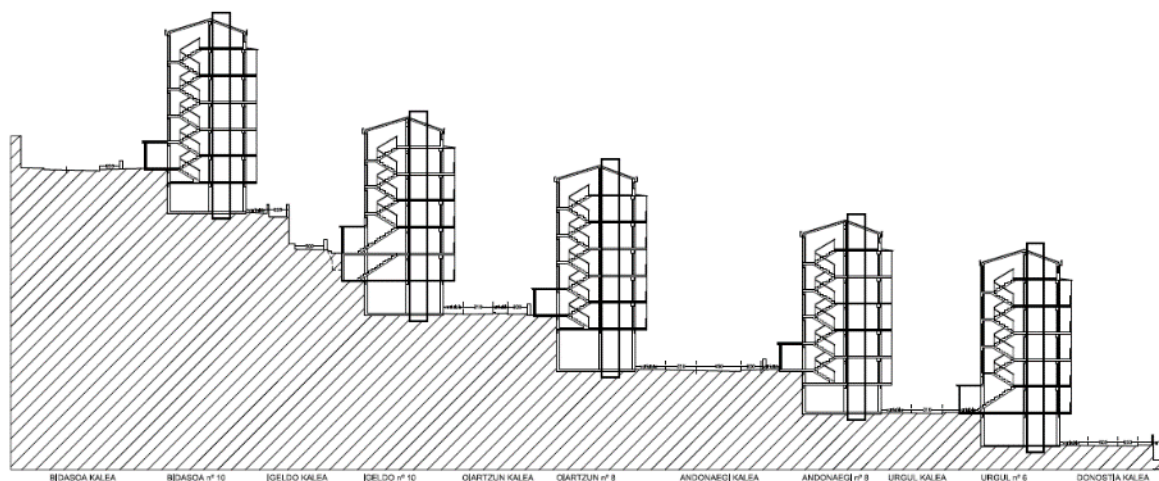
Secciones generales de los bloques sitos en Andonaegi, tras la ejecución del Plan Especial. Fuente: Plano PRO.08-1 del Plan Especial.
